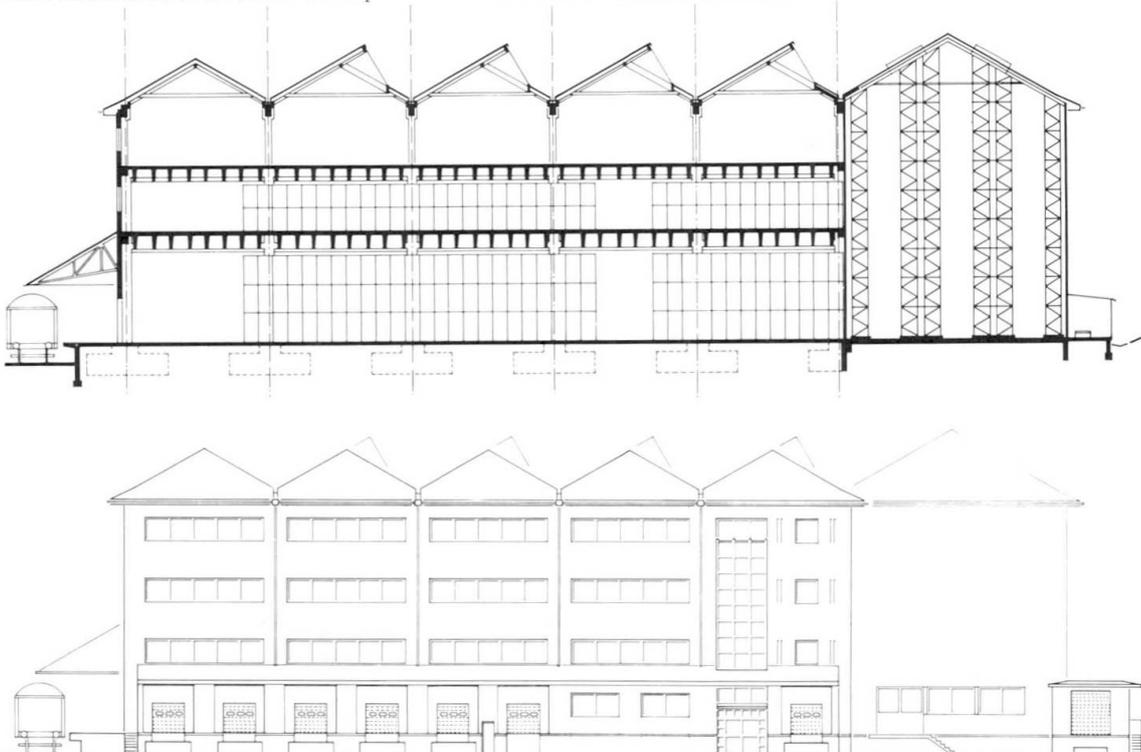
Ein Industriebau mit ziegelgedeckten Walmdächern.
